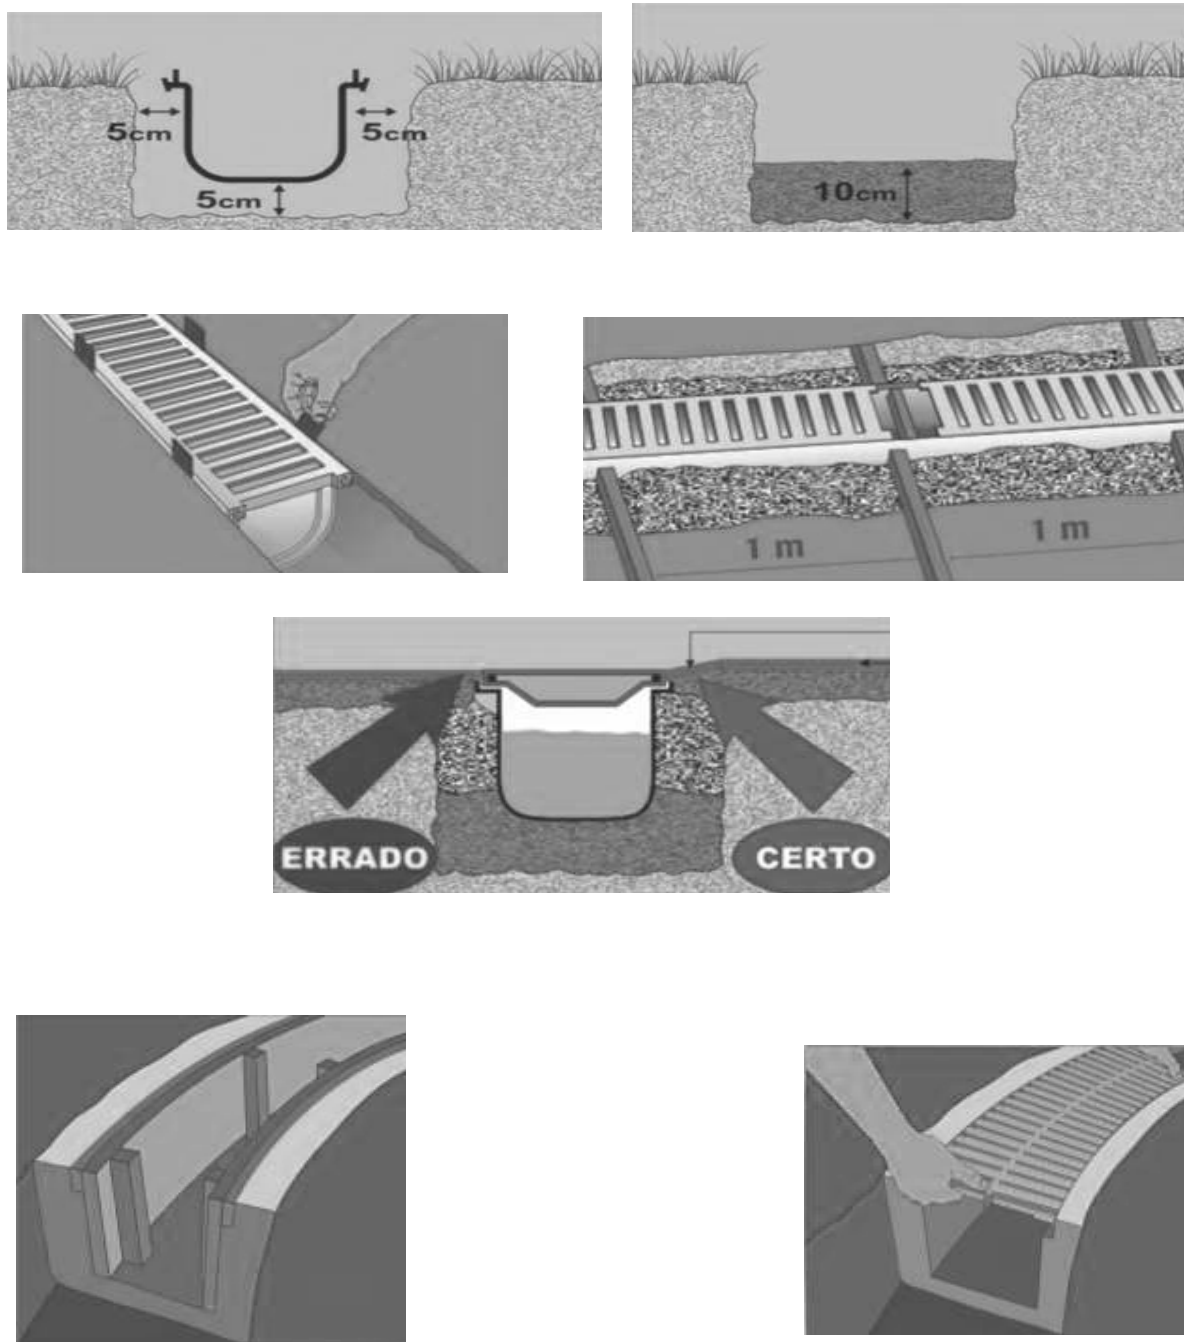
Instalação da calha de piso em PVC e da grelha articulada
